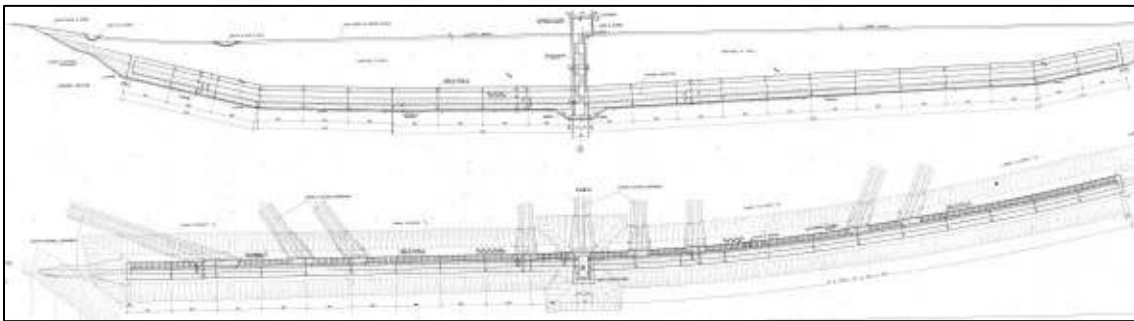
Cunicoli di ispezione delle acque di drenaggio – Planimetria e sezione longitudinale
